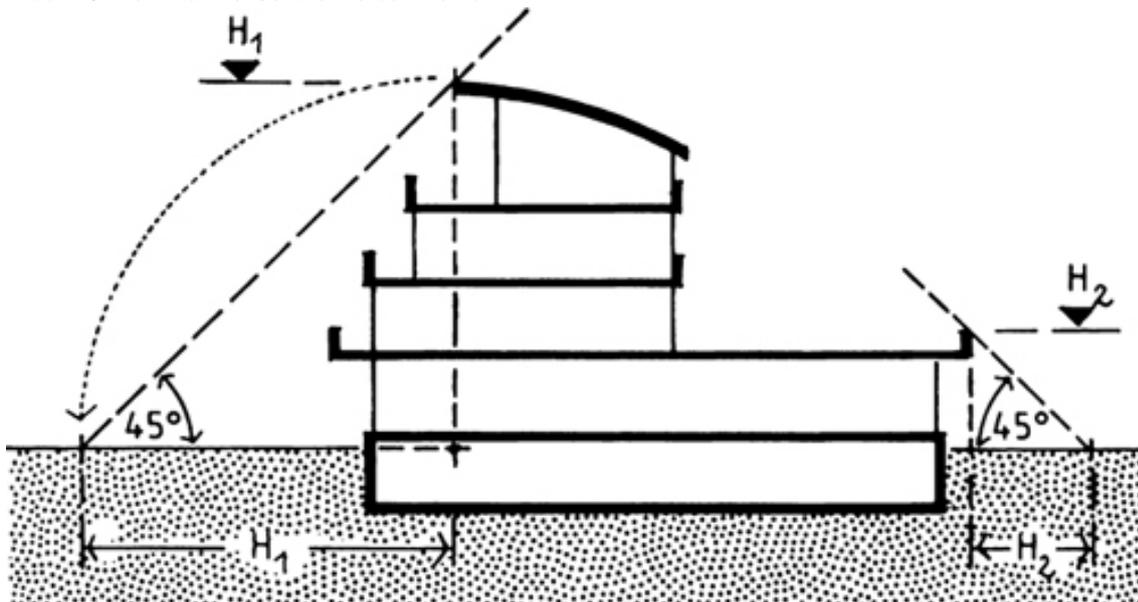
Abstandsflächen und Wandhöhen vor versetzten Außenwänden (Text Ziffer 9)
